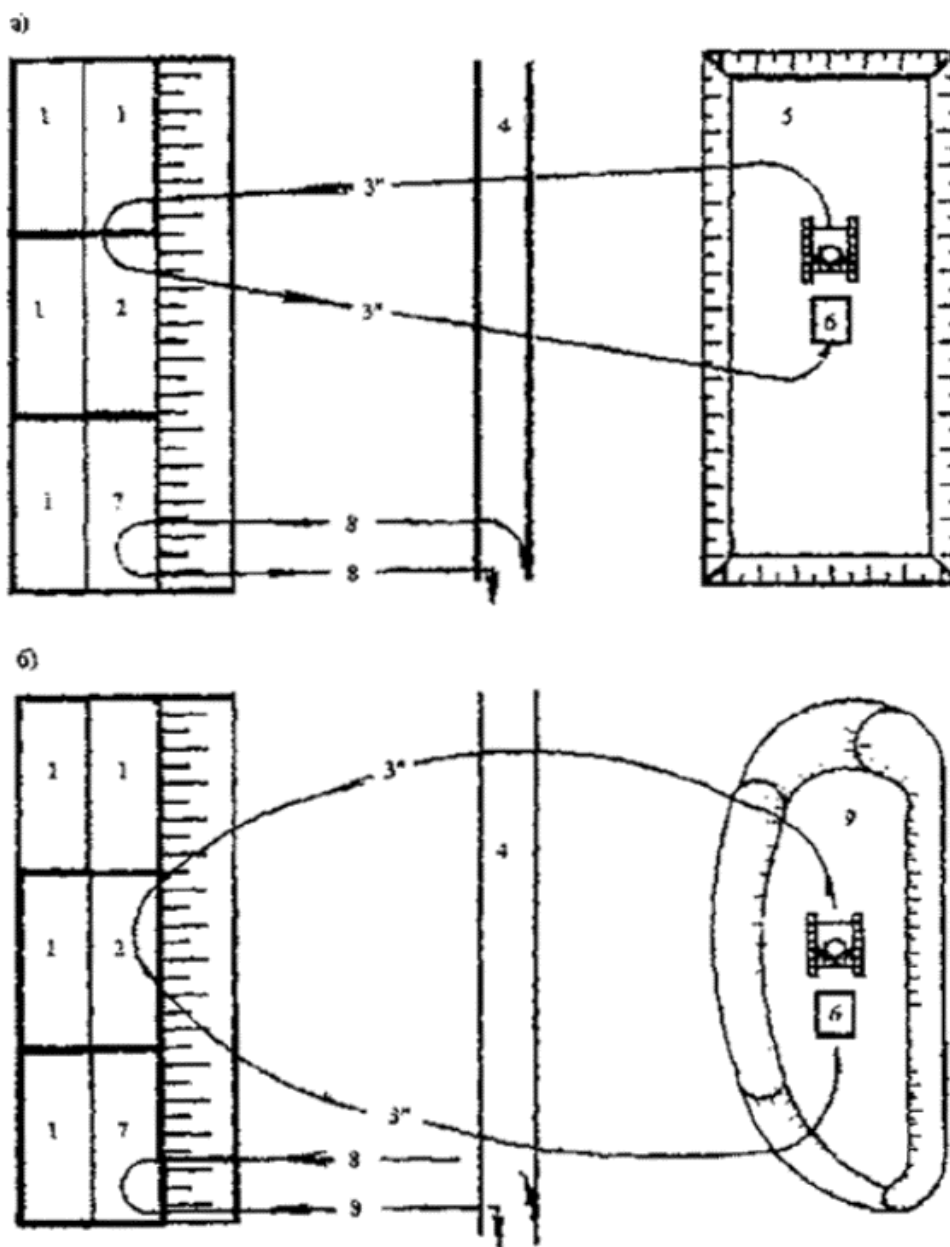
Схема подачи грунта для изоляции ТБО на рабочих картах с помощью скрепера
